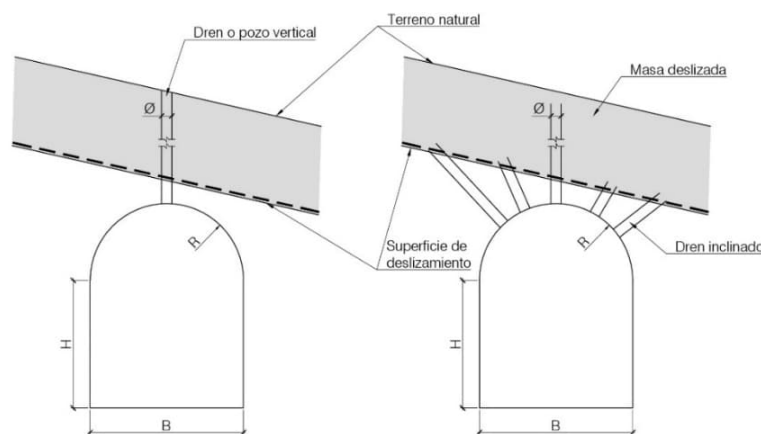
Esquema de posibles diseños conceptuales de las galerías de drenaje
